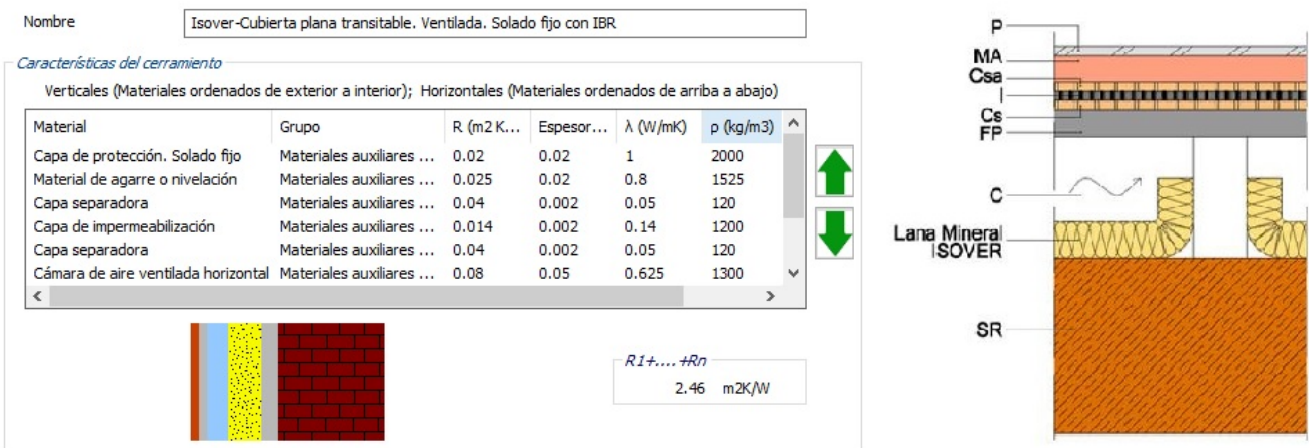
Composición de cubierta (Fuente: Biblioteca CE3x. Complemento Isover)
